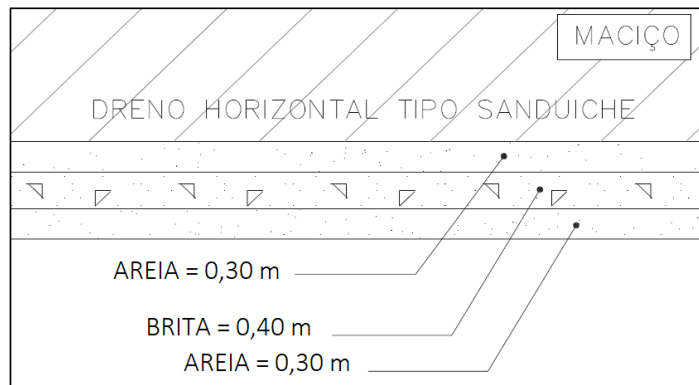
Detalhe do Dreno Horizontal Tipo Sanduíche
